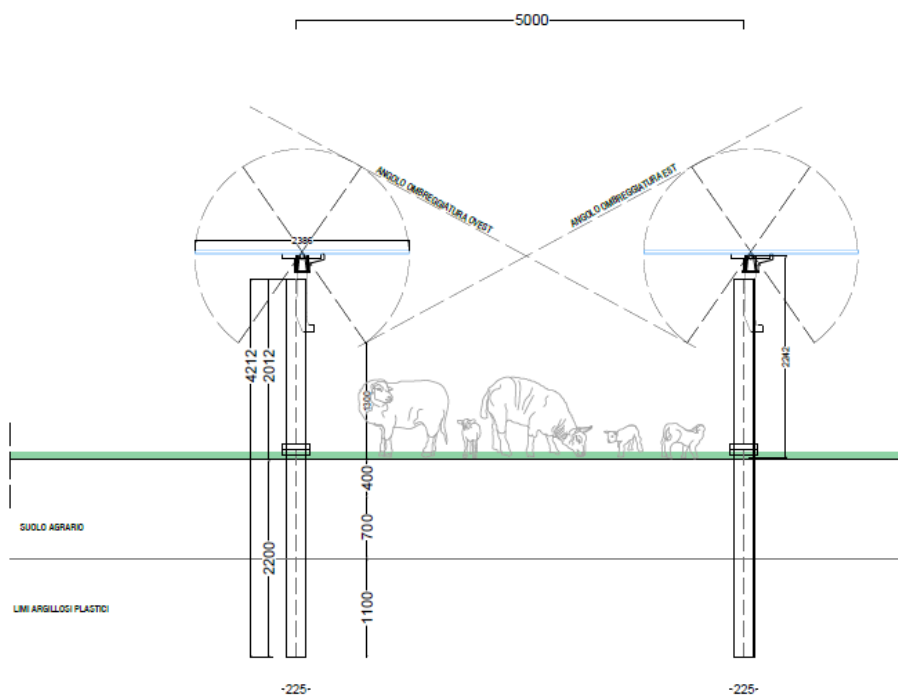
Sezione trasversale tracker in area ad attività zootecnica
